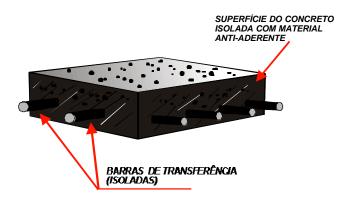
Detalhe de placa de concreto pronta para 2ª etapa da concretagem
